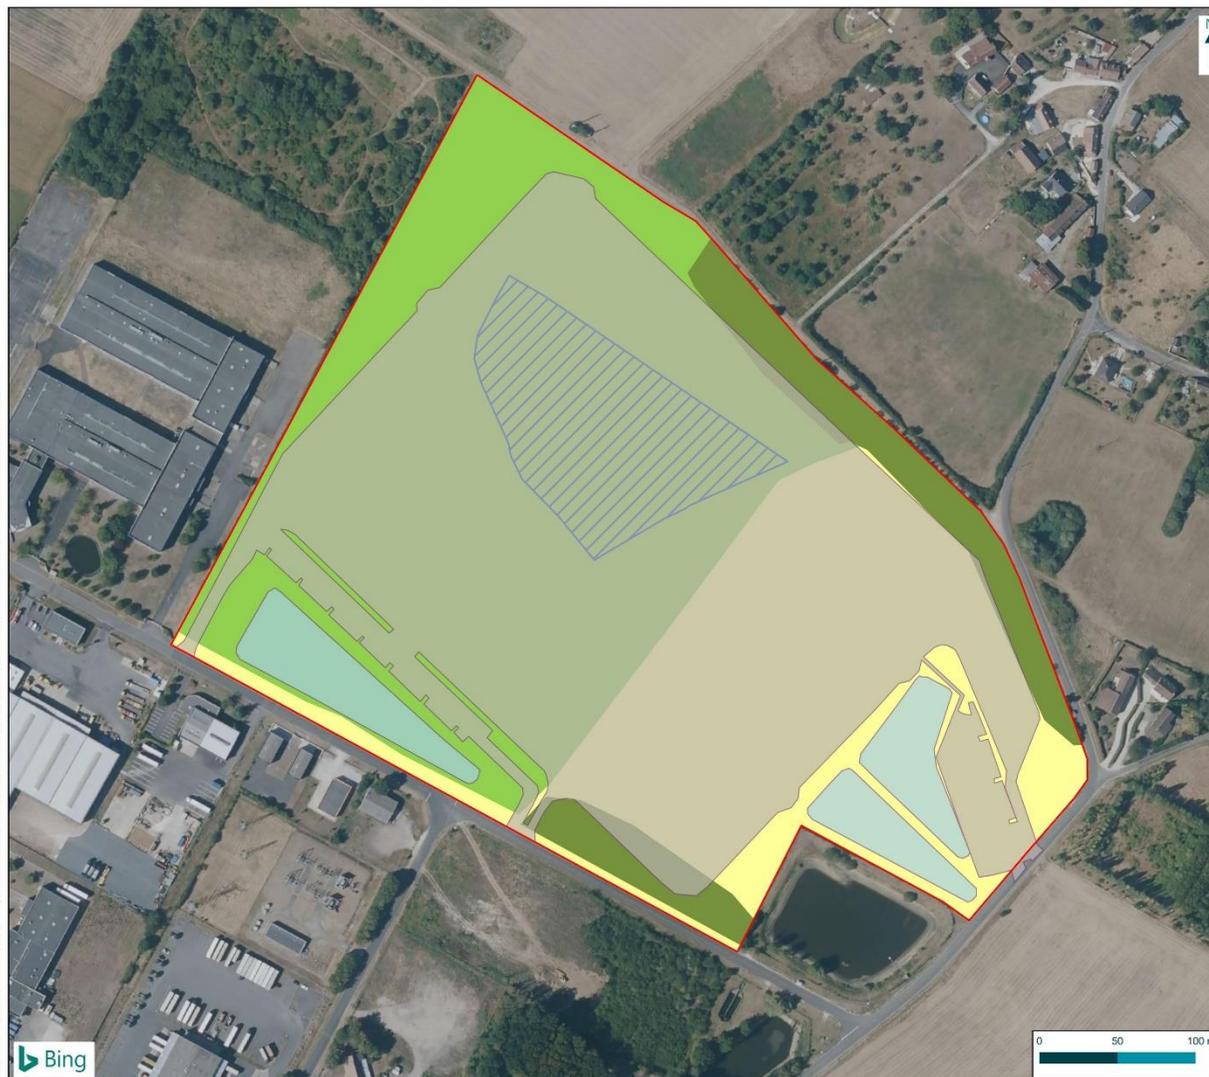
Plan masse de l'étude capacitaire © Barjane
